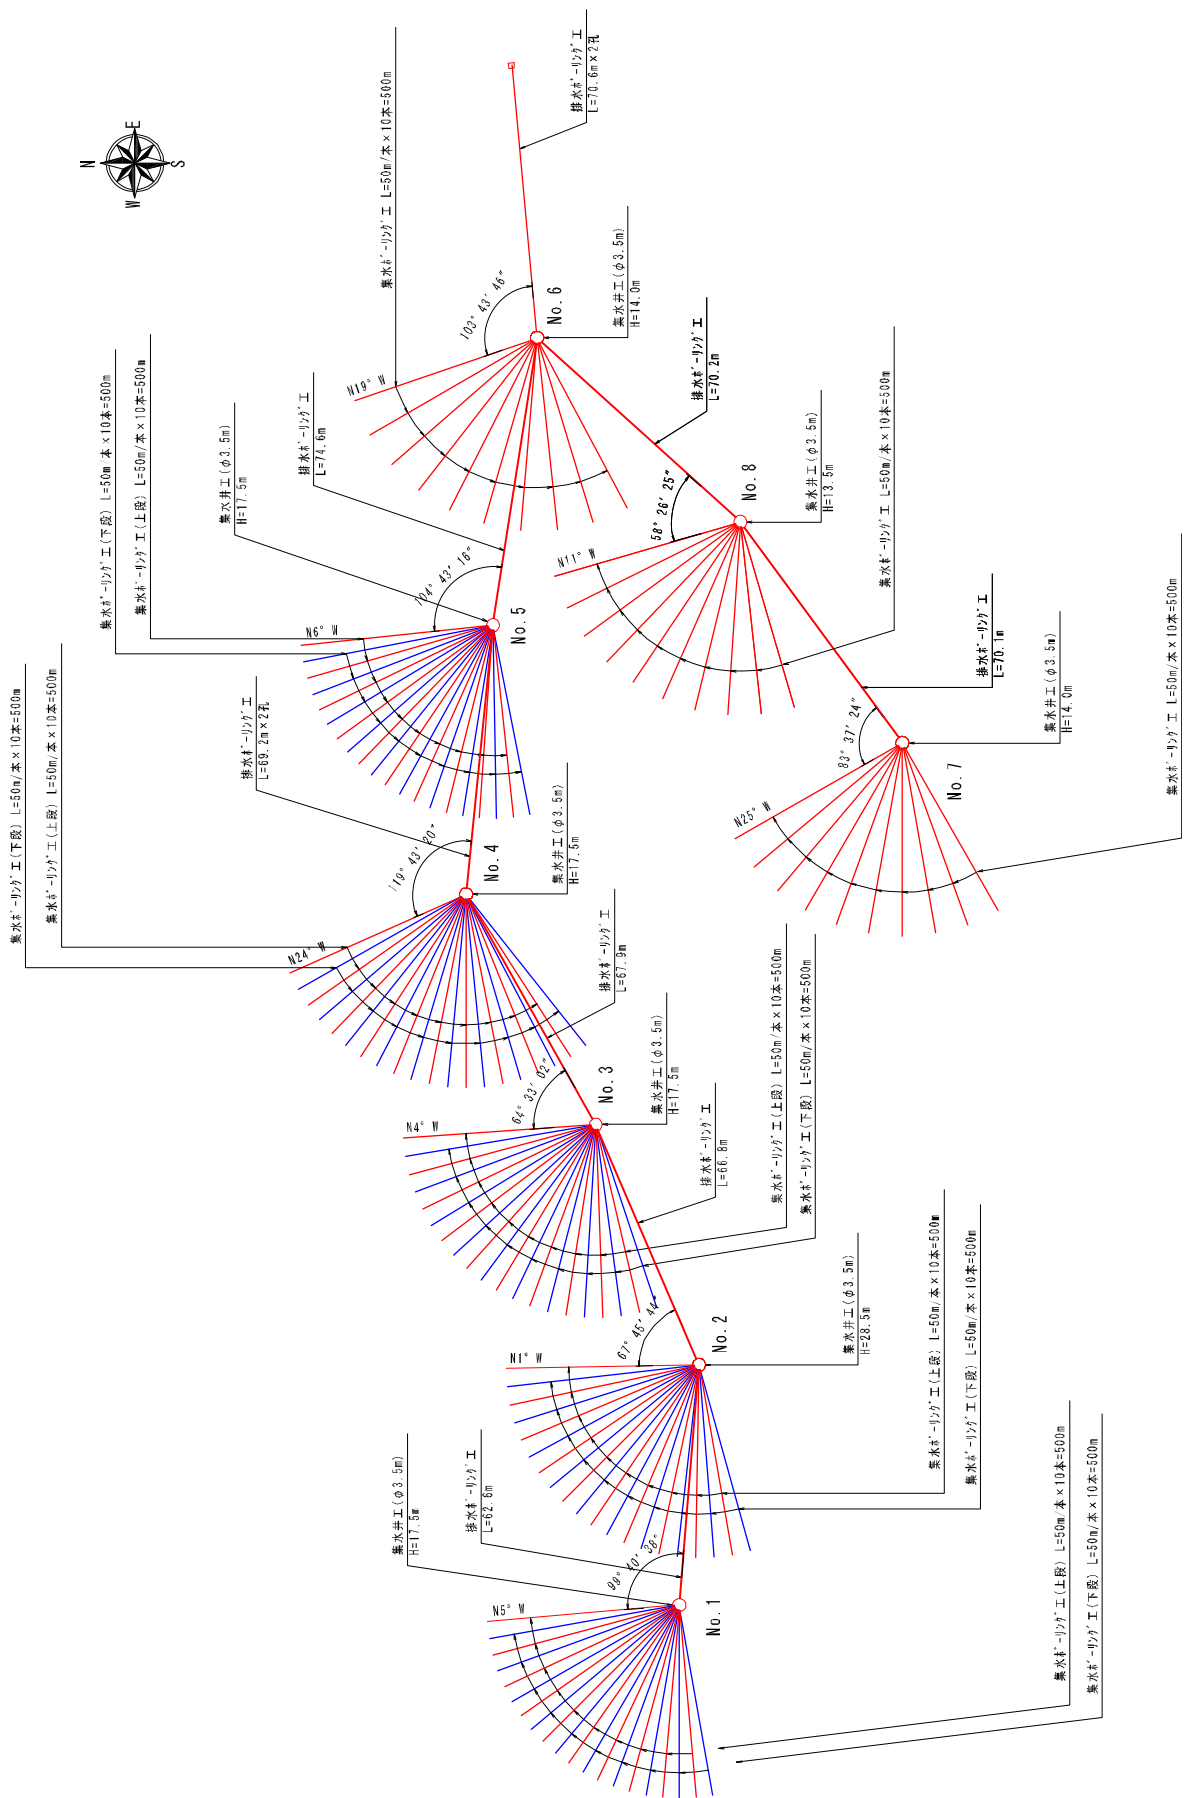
集水井工平面配置図 (エル・ベリンチェ)
